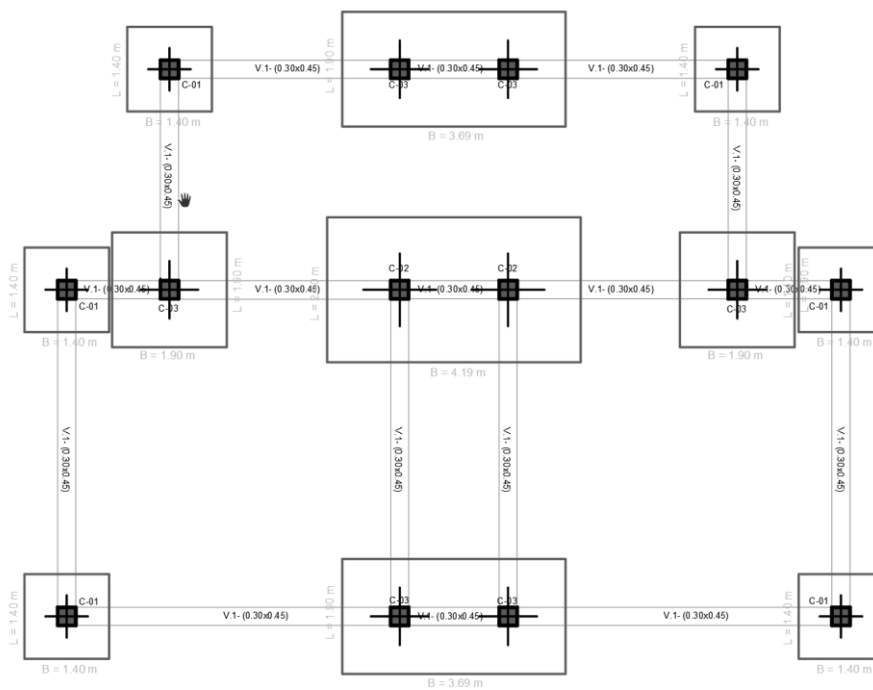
Bloque estructural zona de dormitorios, zapatas
